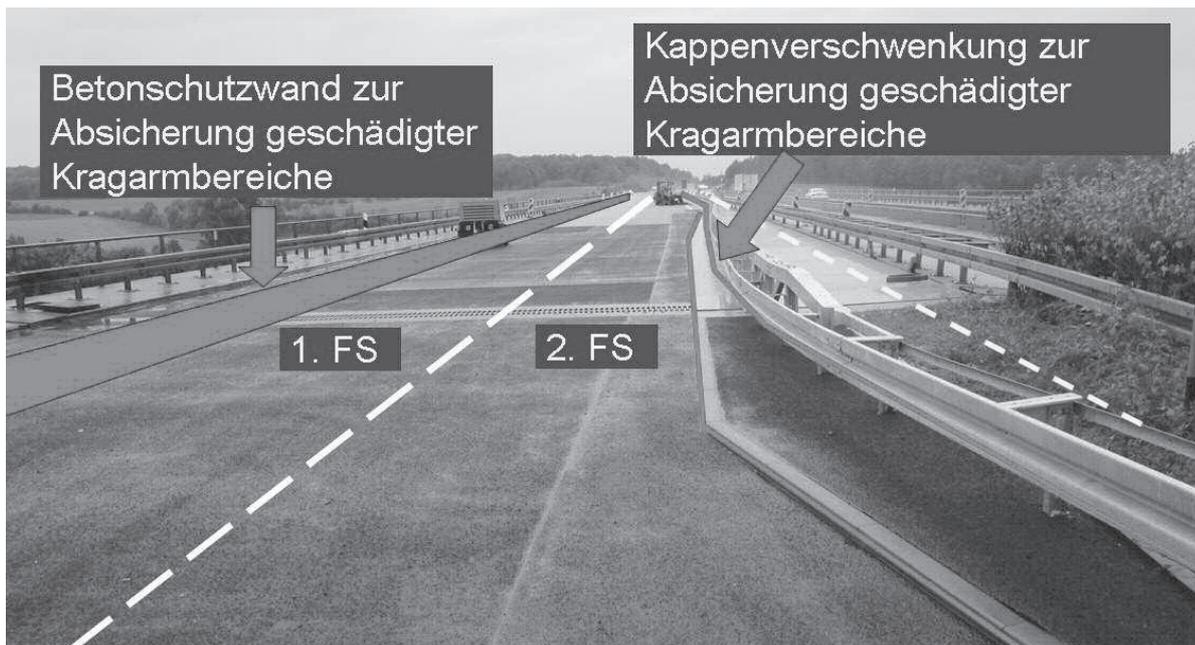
Darstellung der endgültig vorgesehen Verkehrsführung auf TBW 2 mit baulicher Sperrung der geschädigten Kragarme
